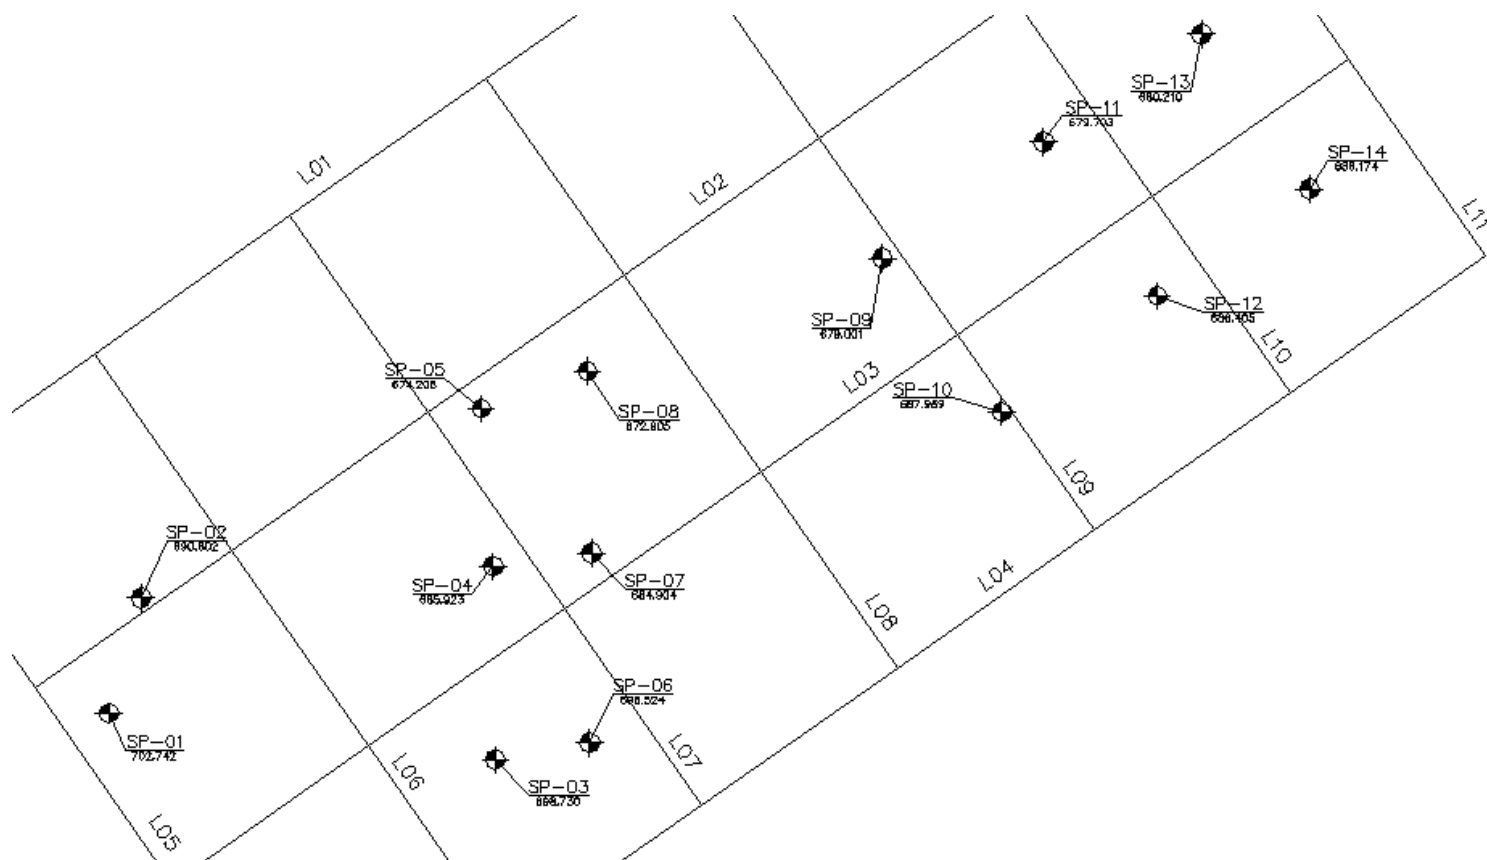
planta de localização dos furos de sondagem e perfis geotécnicos
